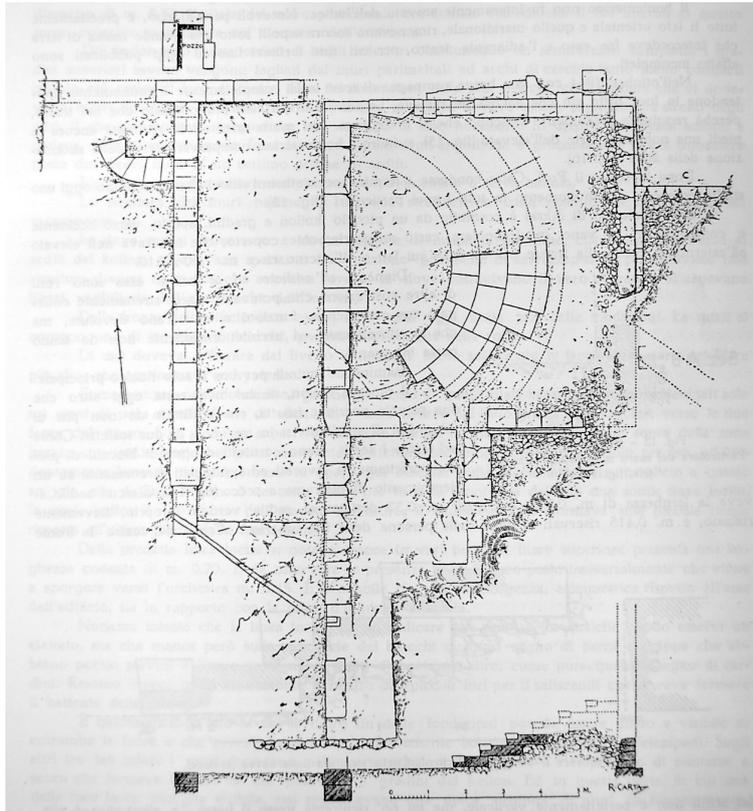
Akrai, pianta del bouleuterion, III sec.a.C. (da BERNABÒ BREA 1956)
